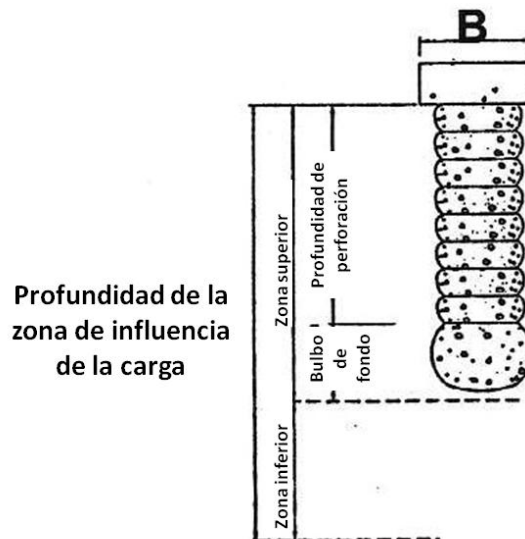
Zonas de un área reforzada con elementos Geopier (Gutiérrez, 2008).
